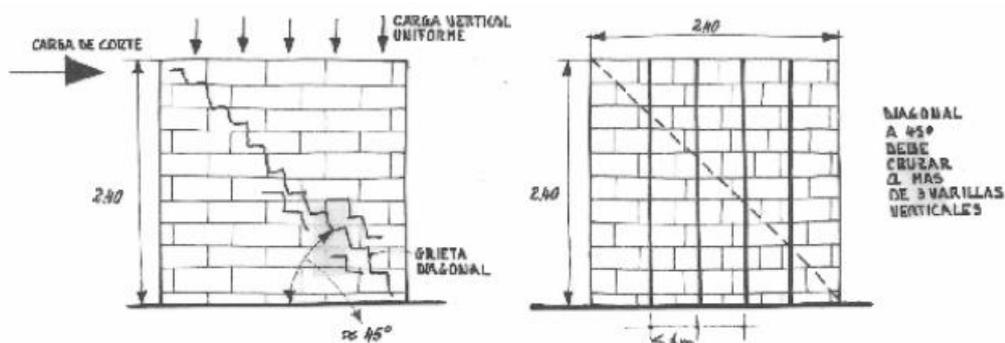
Efectos del refuerzo vertical para el diseño en mampostería reforzada.
